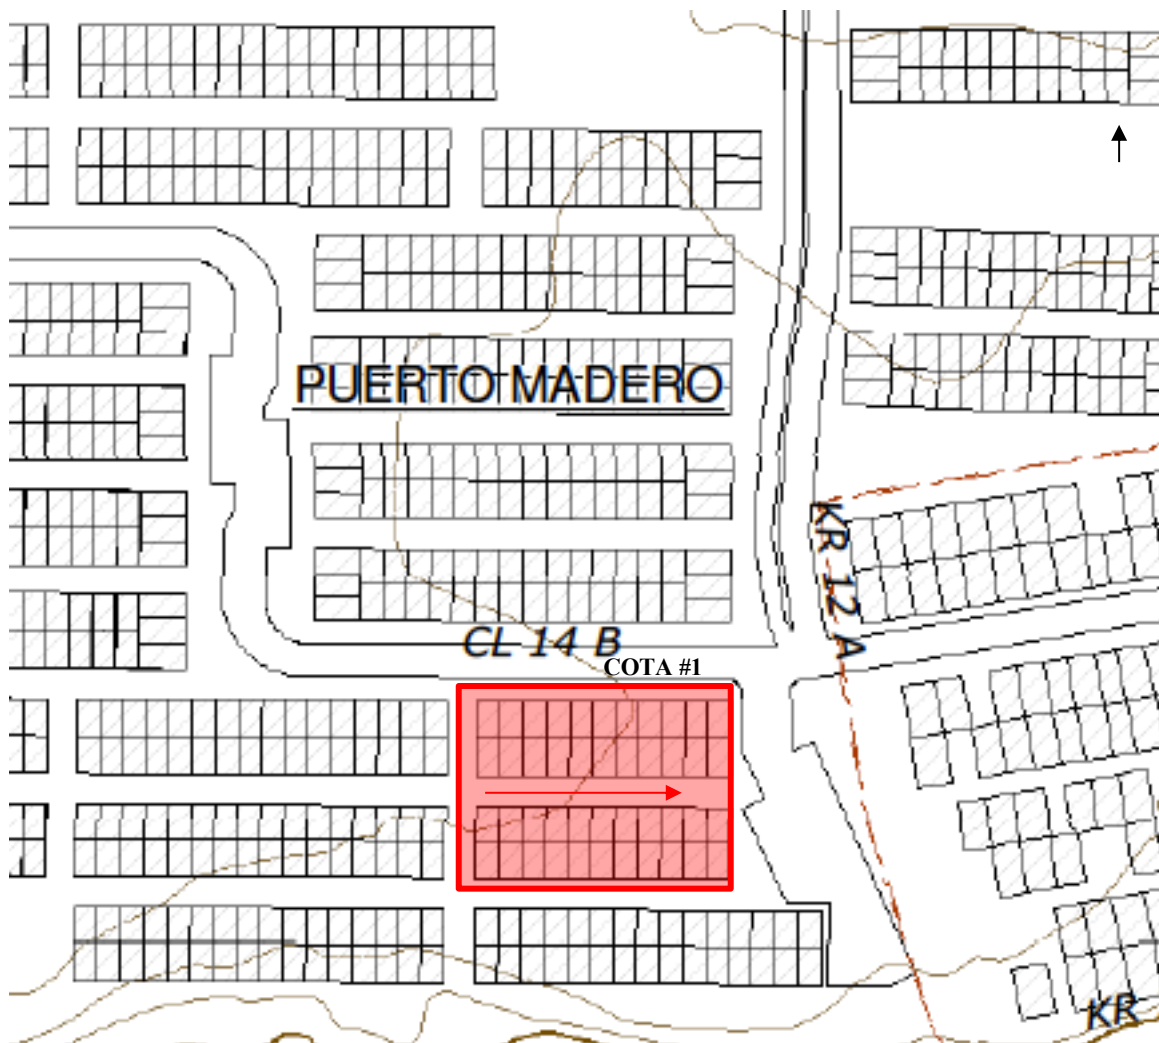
Plano de Ubicación del Lote Dentro del Barrio Puerto Madero
